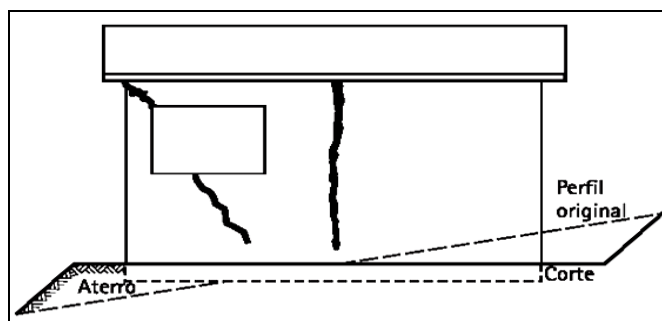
Fissuras características do movimento em fundações de canto
